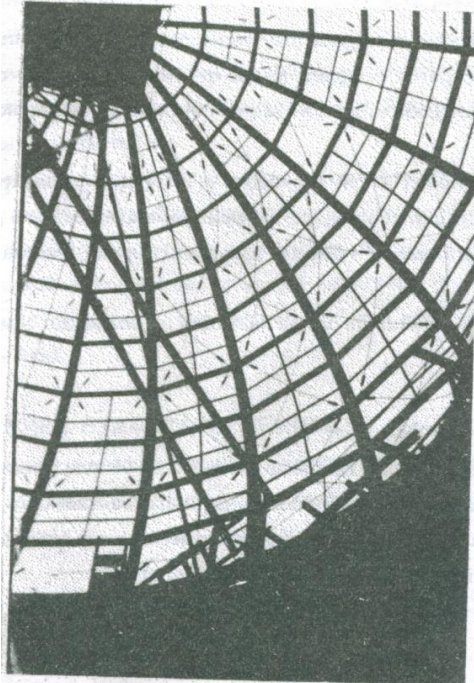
19. Prinderea panelor de inele prin sudură, vedere interioară, cupolă CJ Arad [12]
